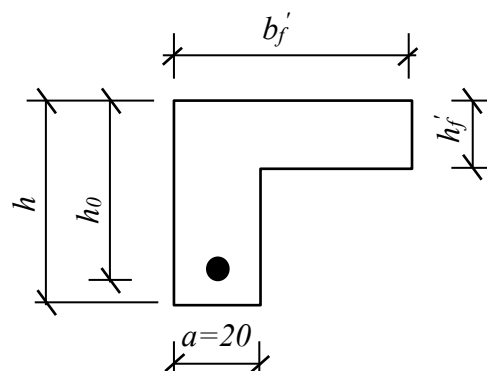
Розрахункова схема для розрахунку лобового ребра
